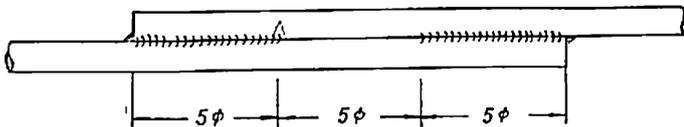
13. Сварной стык внахлестку
